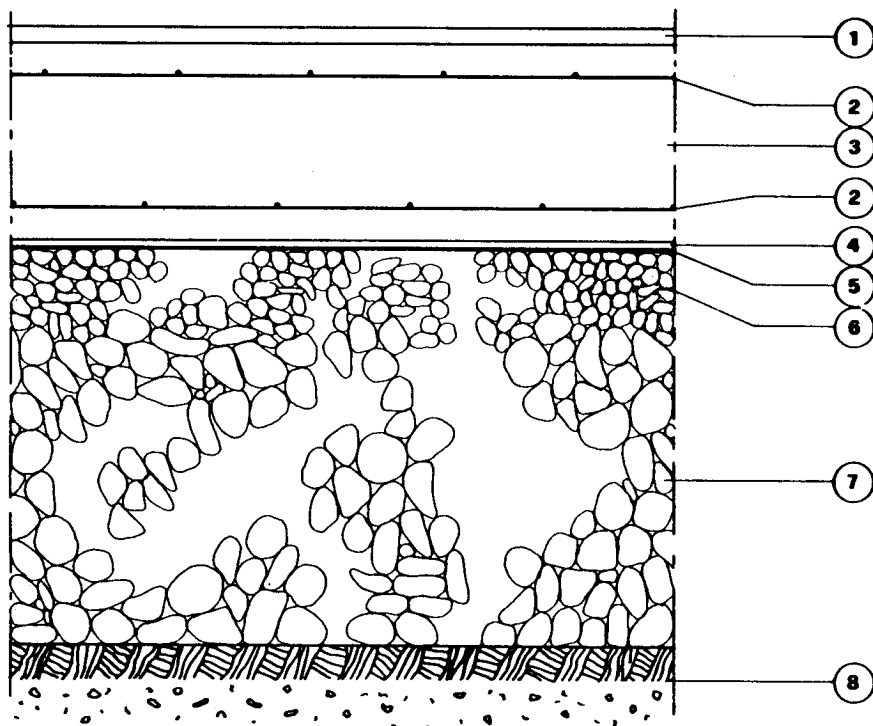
Sezione di pista con manto sintetico e sottofondo in conglomerato cementizio
